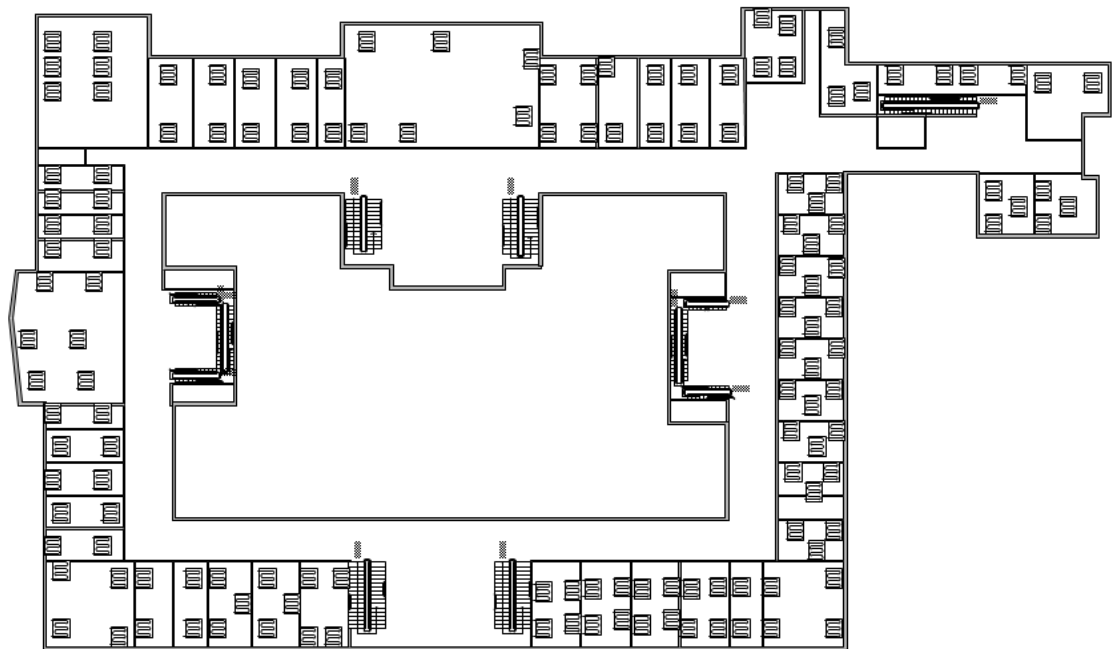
Схема розташування опалювальних пристроїв в першому корпусі
